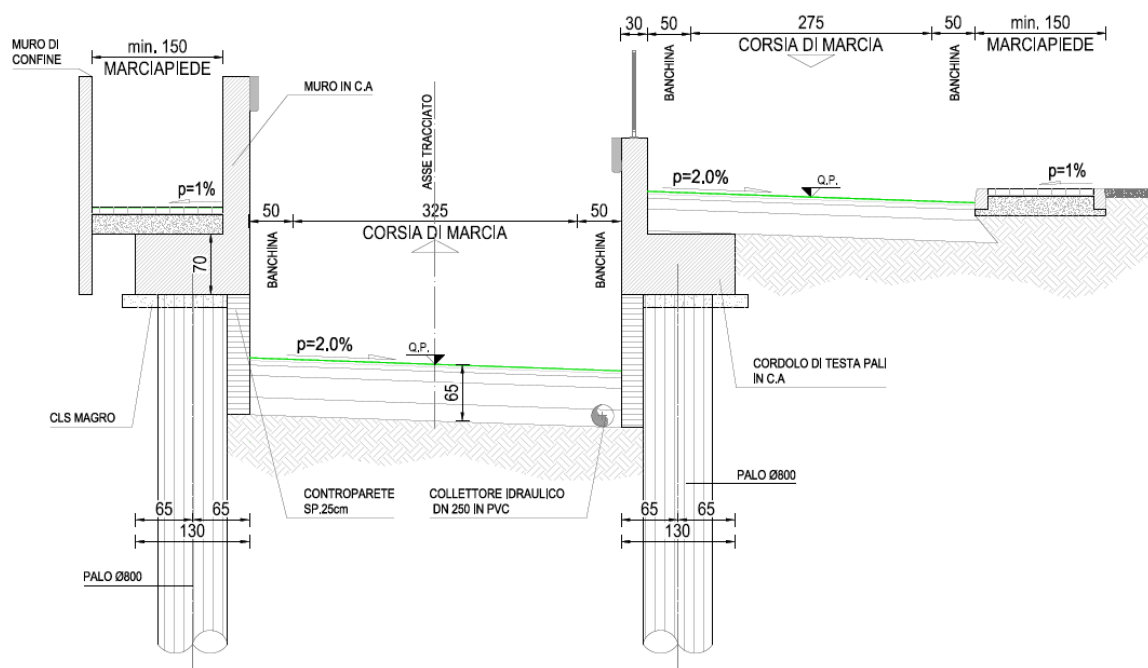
Sezione tipo rampa di accesso al manufatto di progetto – Via San Francesco
